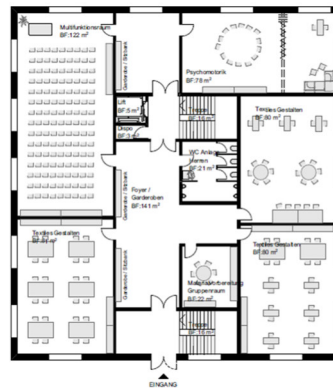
Disposition 02 | Grundriss 1. Obergeschoss
